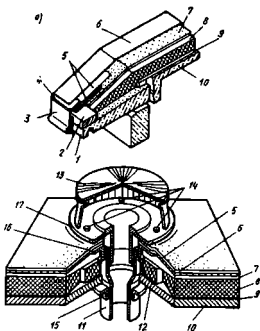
Конструкции отвода воды с покрытий промышленных зданий:
